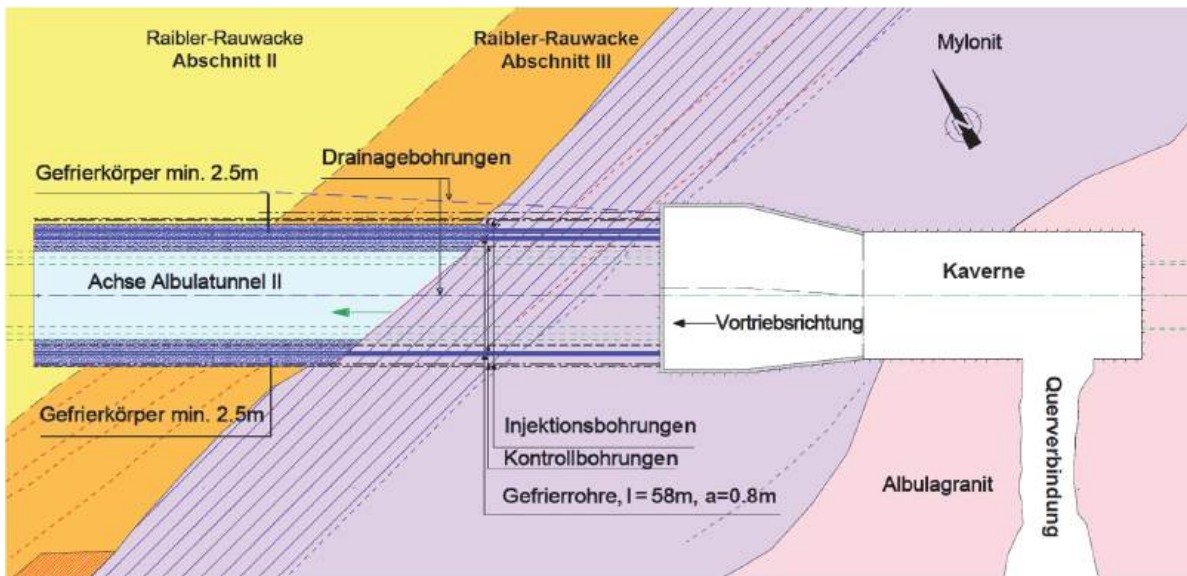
Konzept Gefrierkörper und Gegenvortrieb im Abschnitt III der Rauwacke – Grundriss
